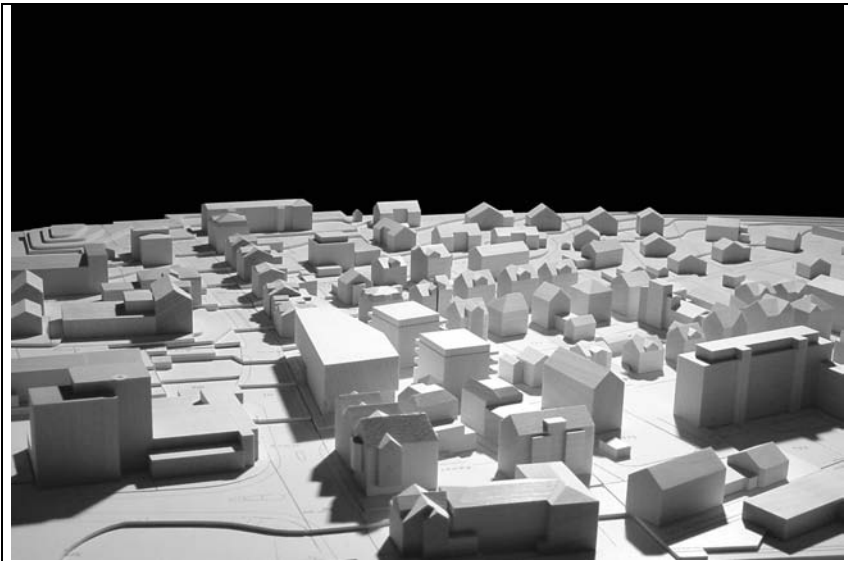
Modellansicht Nord mit bestehenden Bauten in der Umgebung
